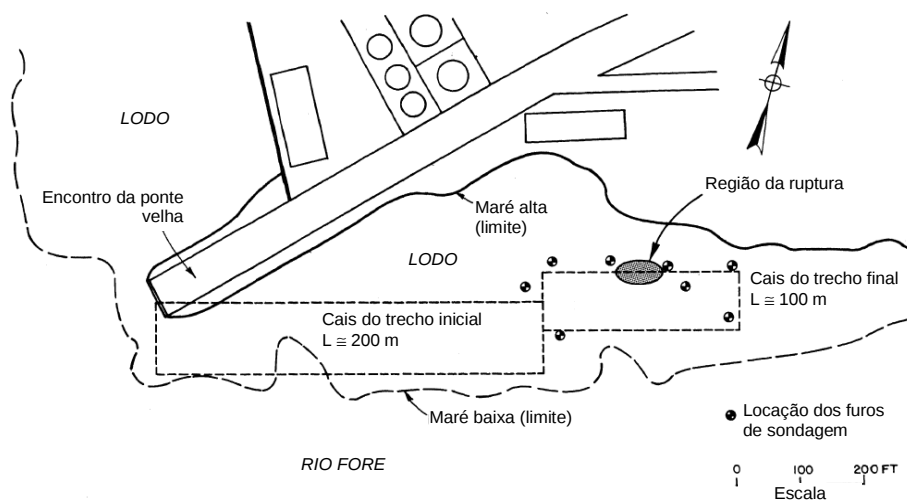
Localização da Obra - adaptado de LaGatta e Shields (1984)
